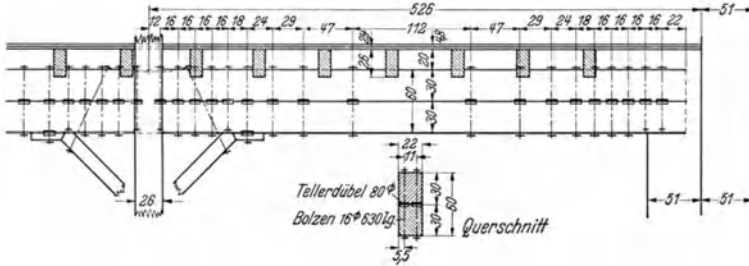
Verdübelter Balken als Deckenunterzug. Sackspeicher der Kaliwerke Aschersleben, Schachtanlage Hattorf.
